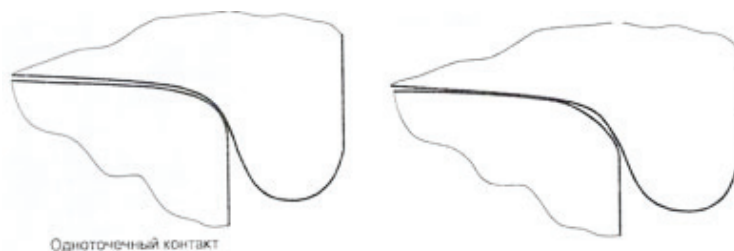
Снятие металла с рабочей выкружки головки рельса при одноточечном контакте
